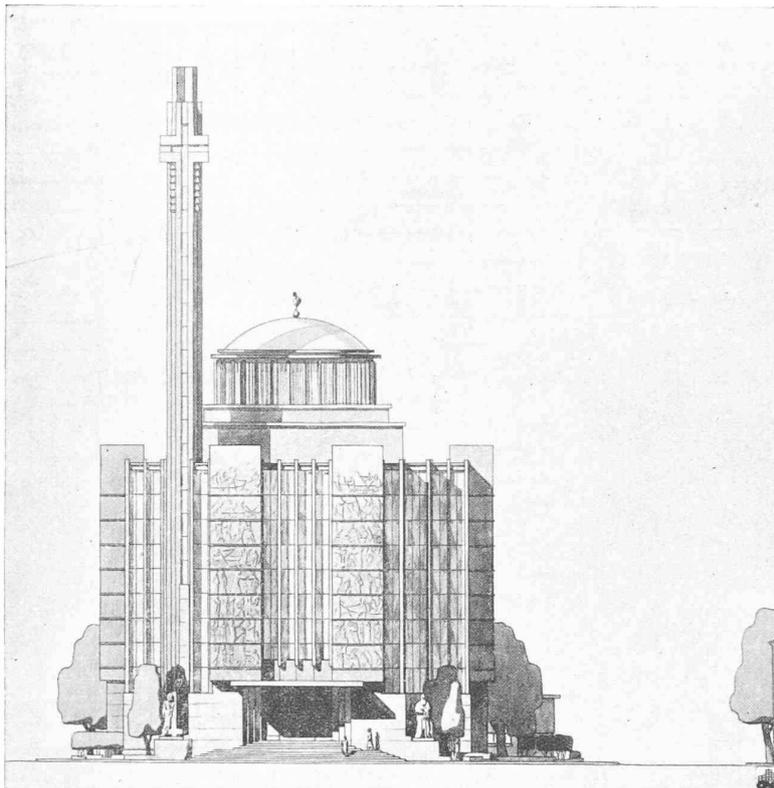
Façade principale de la nouvelle église en acier, projetée.
